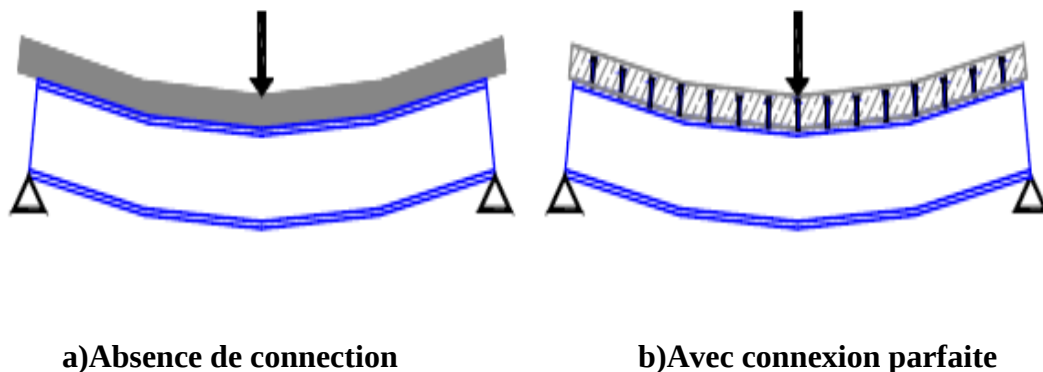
L'impact de la connexion dans les poutres mixtes [27].
